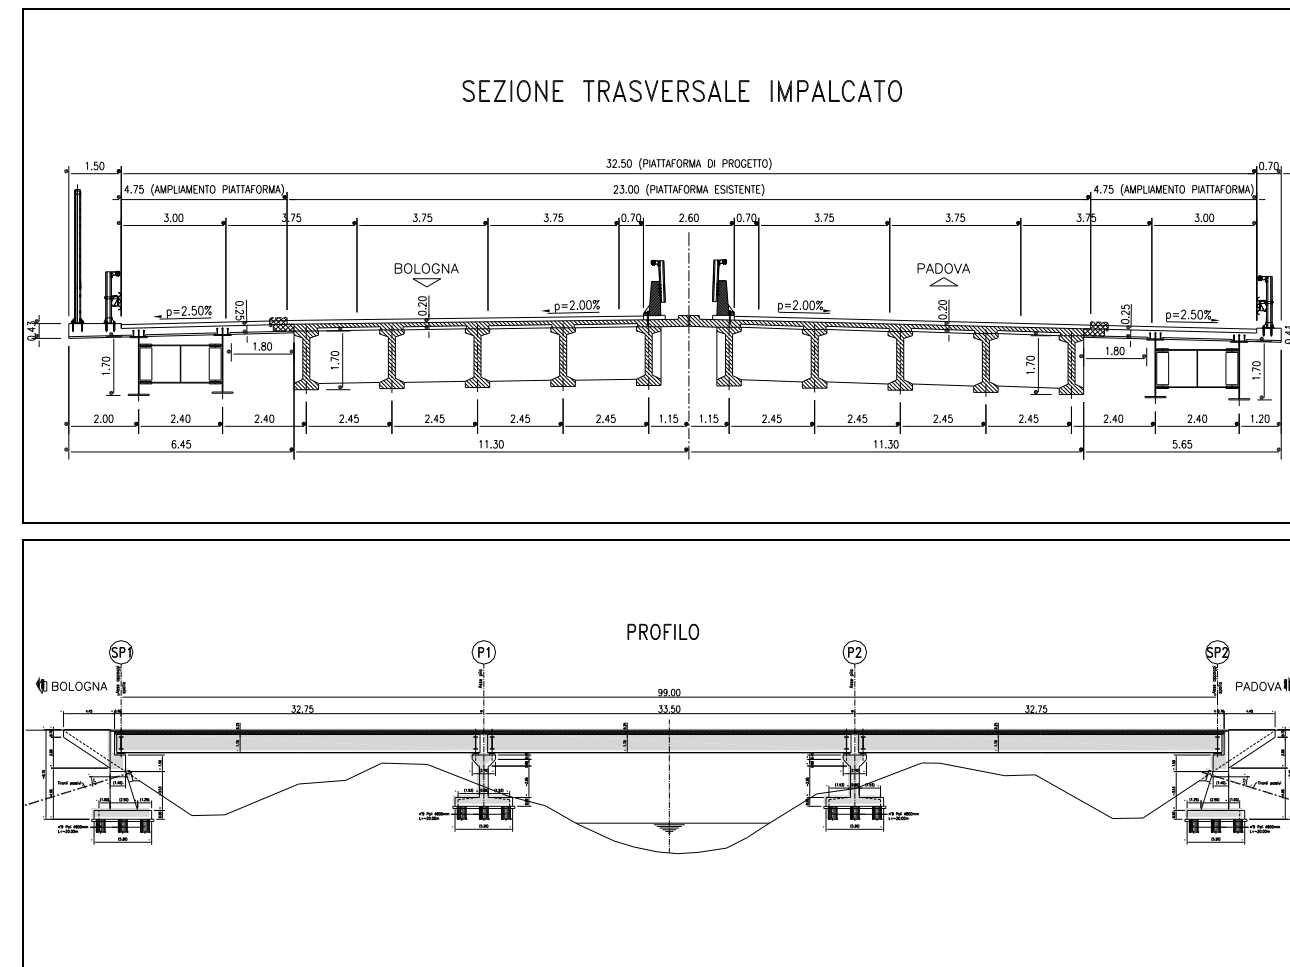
Sezione dell'impalcato e profilo del ponte sul canale Vigenzone
